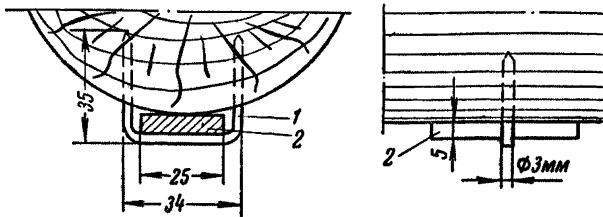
Крепление заземляющего проводника в выработке с деревянной крепью:
